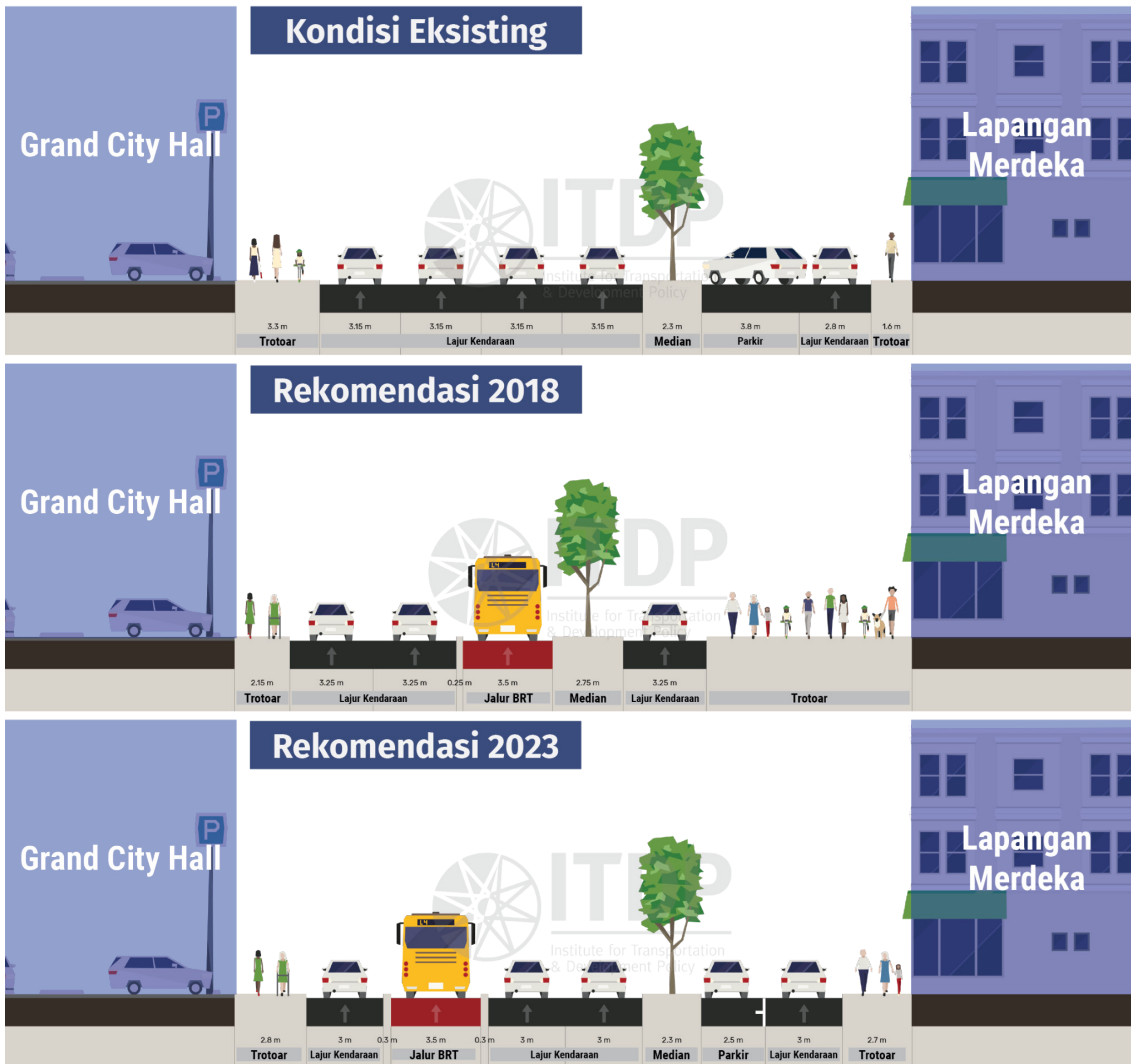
Ragam intervensi pada ruang Jalan Raden Saleh
